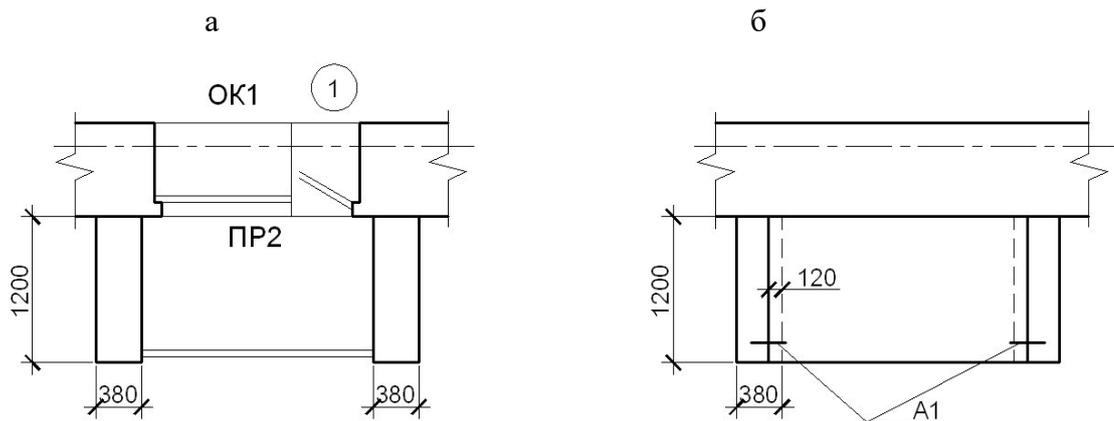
Планы лоджий: а – на плане этажа, б – на плане перекрытий.
